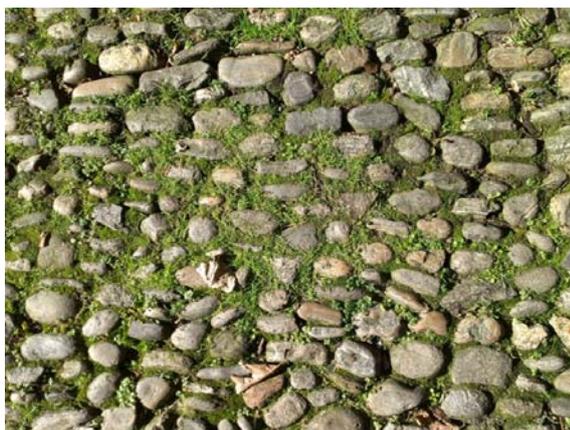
esempi di pavimentazione semi-permeabile in pietra.
